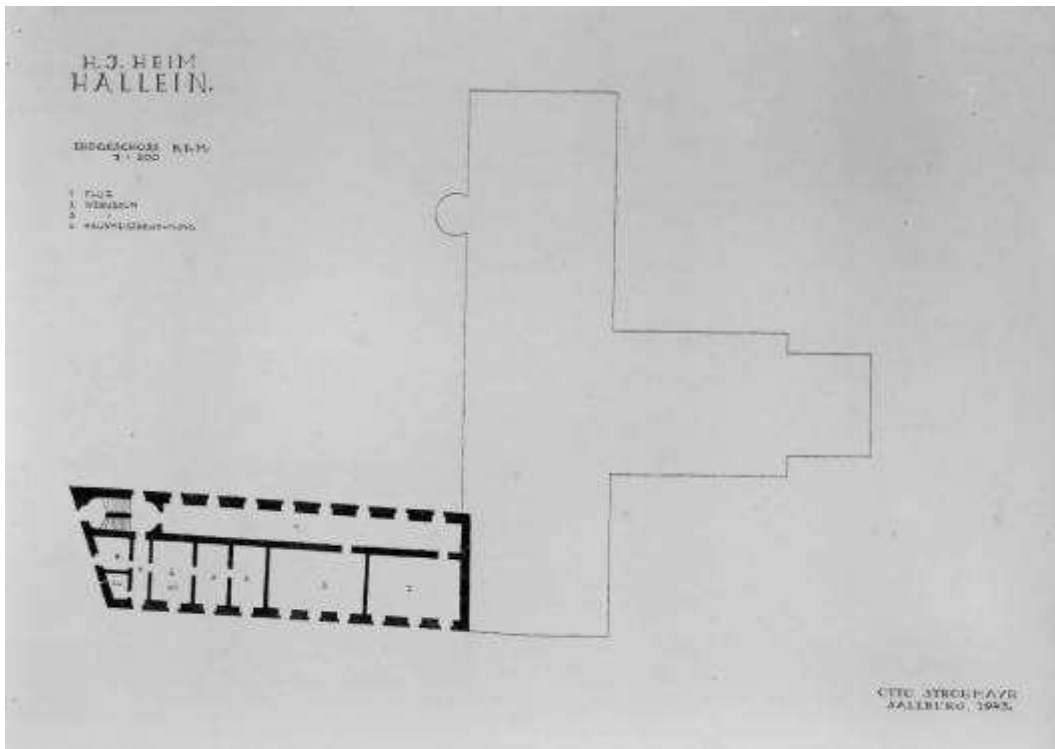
Otto Strohmayer, Grundriss, *Erdgeschoss B. D. M., H. J. Heim, Hallein*, 1943 (HSS, INR 4.564, 4.568, 4.569, 4.570, 4.571).
